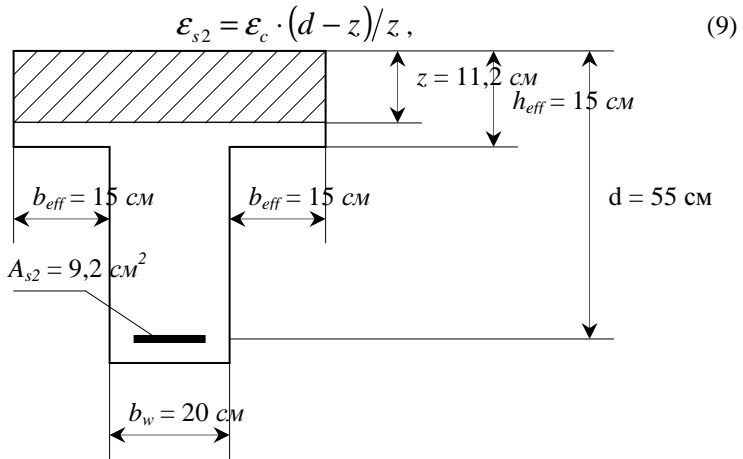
Схема поперечного перерізу елемента при положенні нейтральної лінії в полиці
